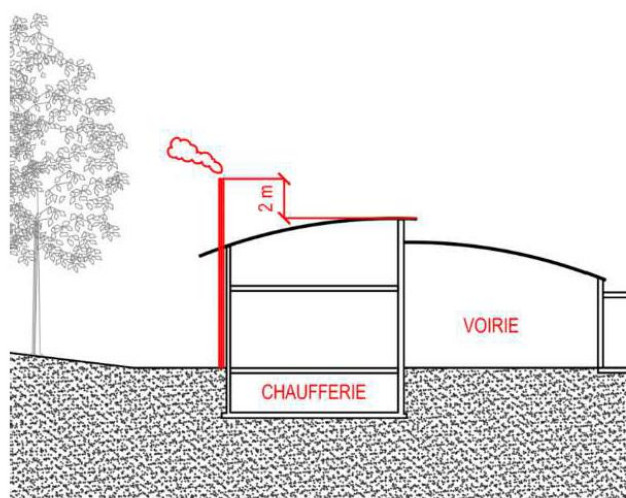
Coupe de principe du prolongement de la cheminée existante
